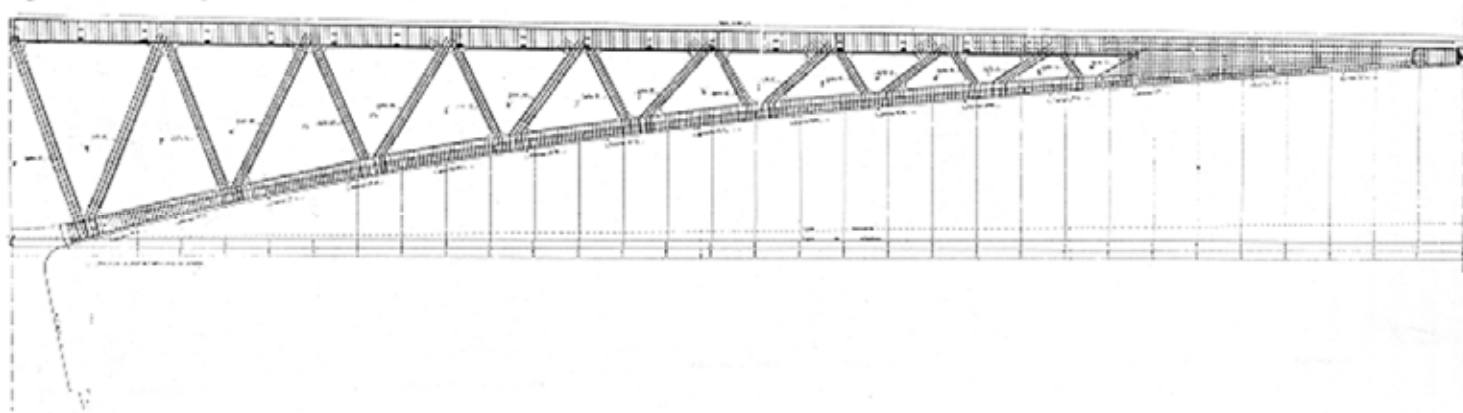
Planos del puente sobre el río Veurdre. Secciones longitudinales. Ancho columna 185 mm.
